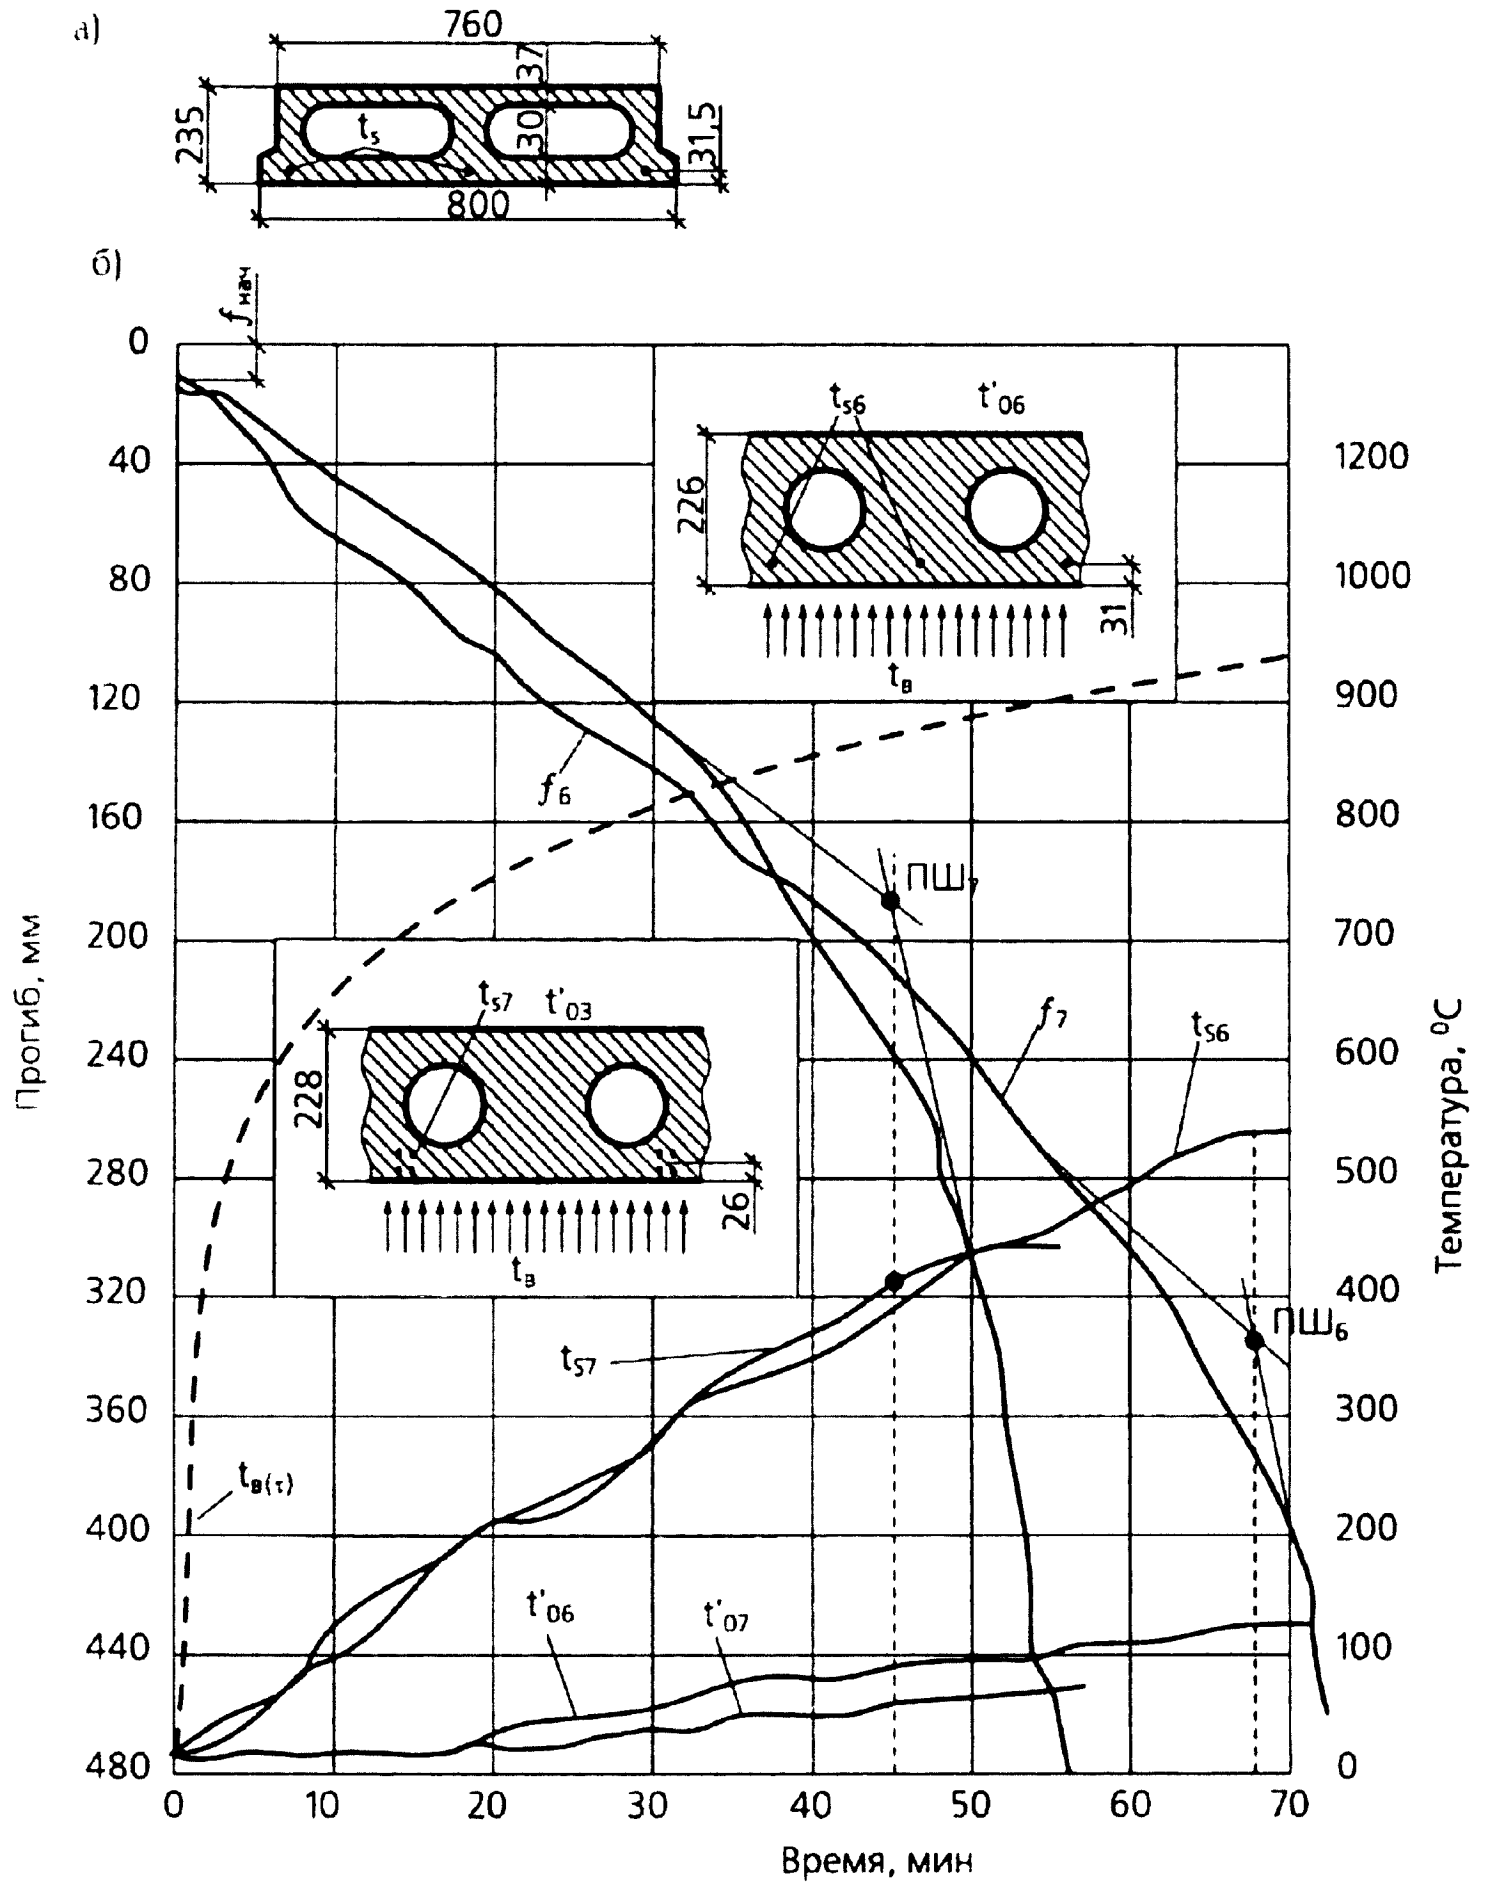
Испытание на огнестойкость многопустотных панелей перекрытий:
